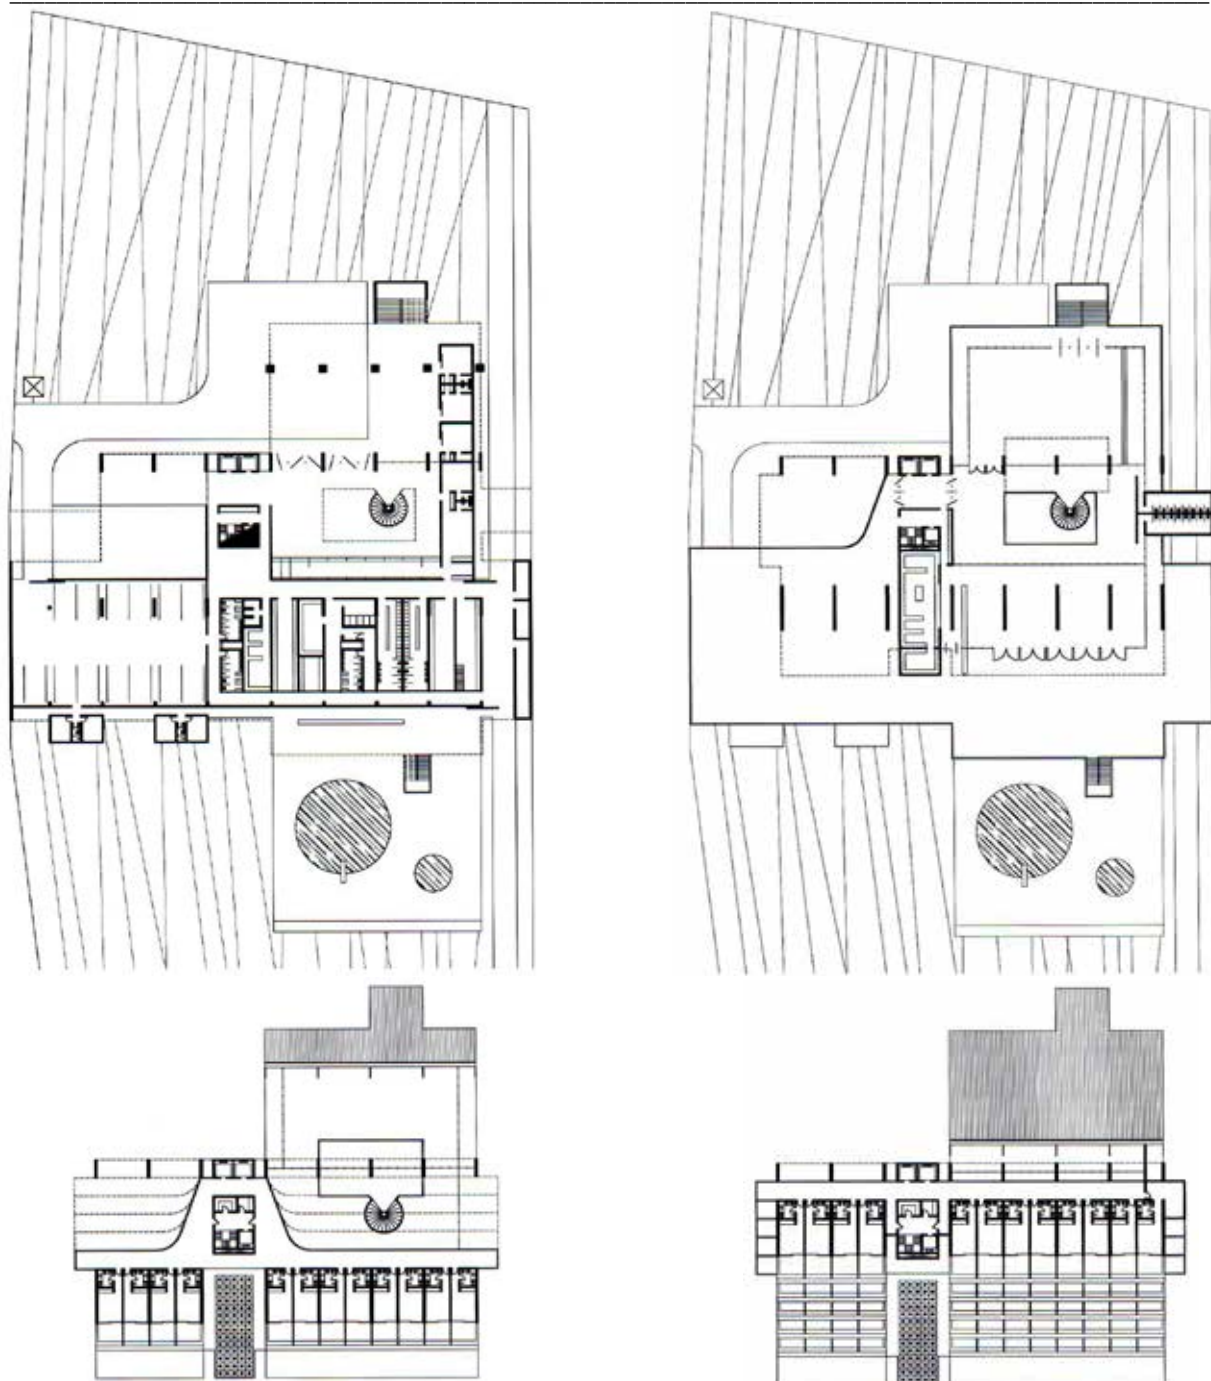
(sup. esq.) 1º prêmio; planta pavimento térreo.
